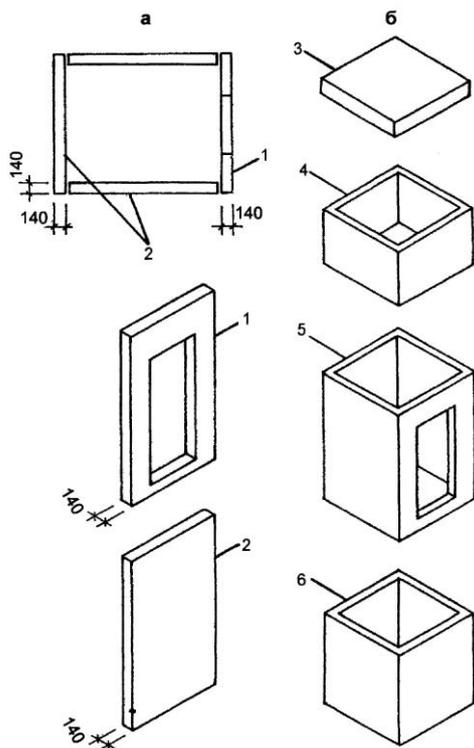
Элементы сборных лифтовых шахт: а – из плоских панелей; б – из объемных блоков; 1 – панель с дверным проемом; 2 – глухая панель; 3 – плита перекрытия; 4 – доборный верхний блок; 5 – основной блок; 6 – блок прямка
